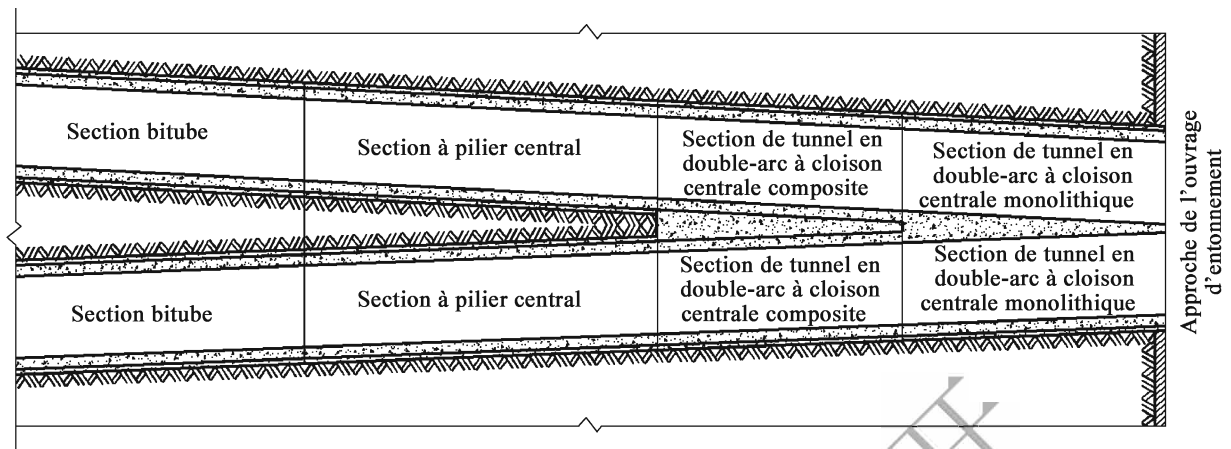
Disposition en plan du revêtement d'ouvrage d'entonnement de type II
